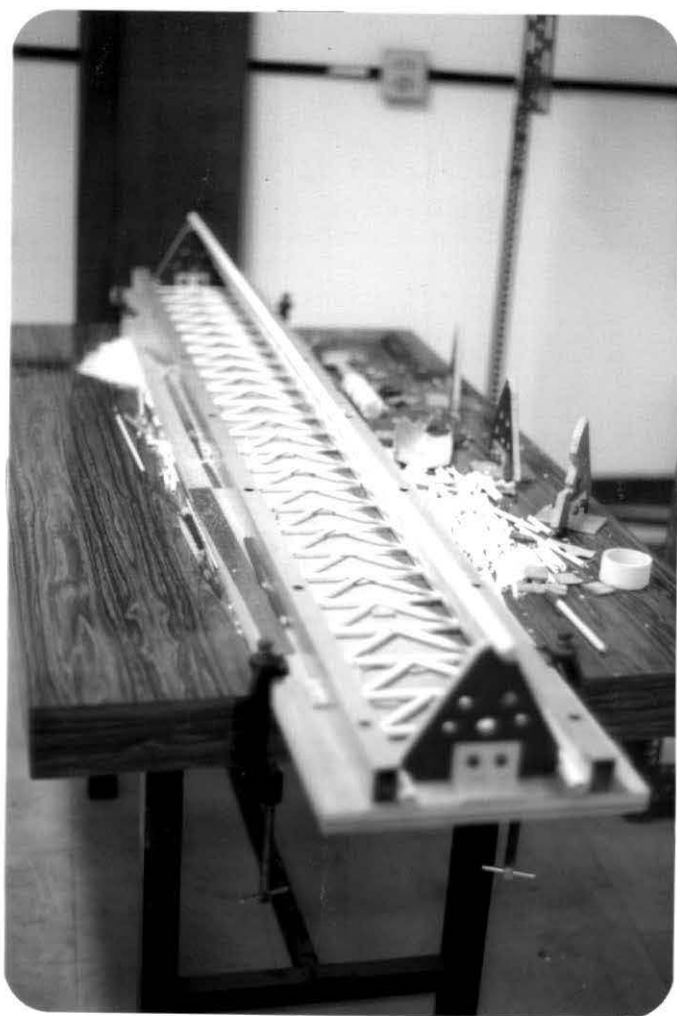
Modelo com a primeira face construída e a segunda em fase de construção
